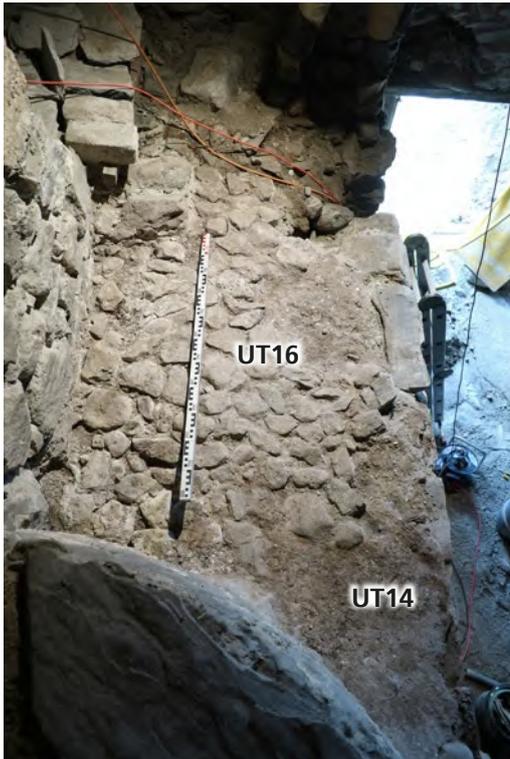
Bâtiment 1, local L. 6. Le sol en pierres (UT16) était fondé sur un remblai maintenu par un mur de soutènement (UT14) fondé sur le rocher et soutenant également l'extrémité des planches du sol en bois couvrant la cave. Vue du nord.
